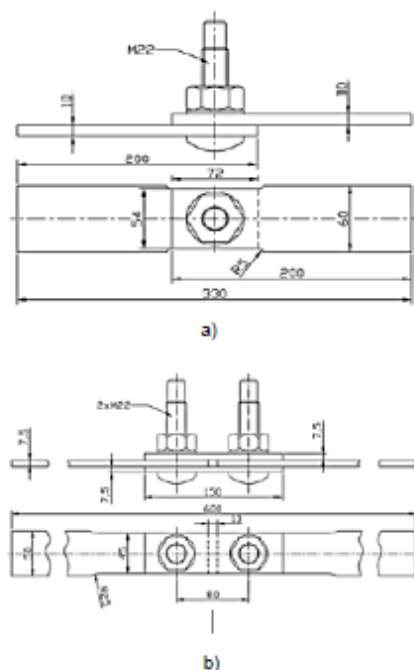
Geometria dos provetes: a) provetes com ligação de corte simples; b) provete com ligação de corte duplo (dimensões em mm) (De Jesus et al., 2010b)
